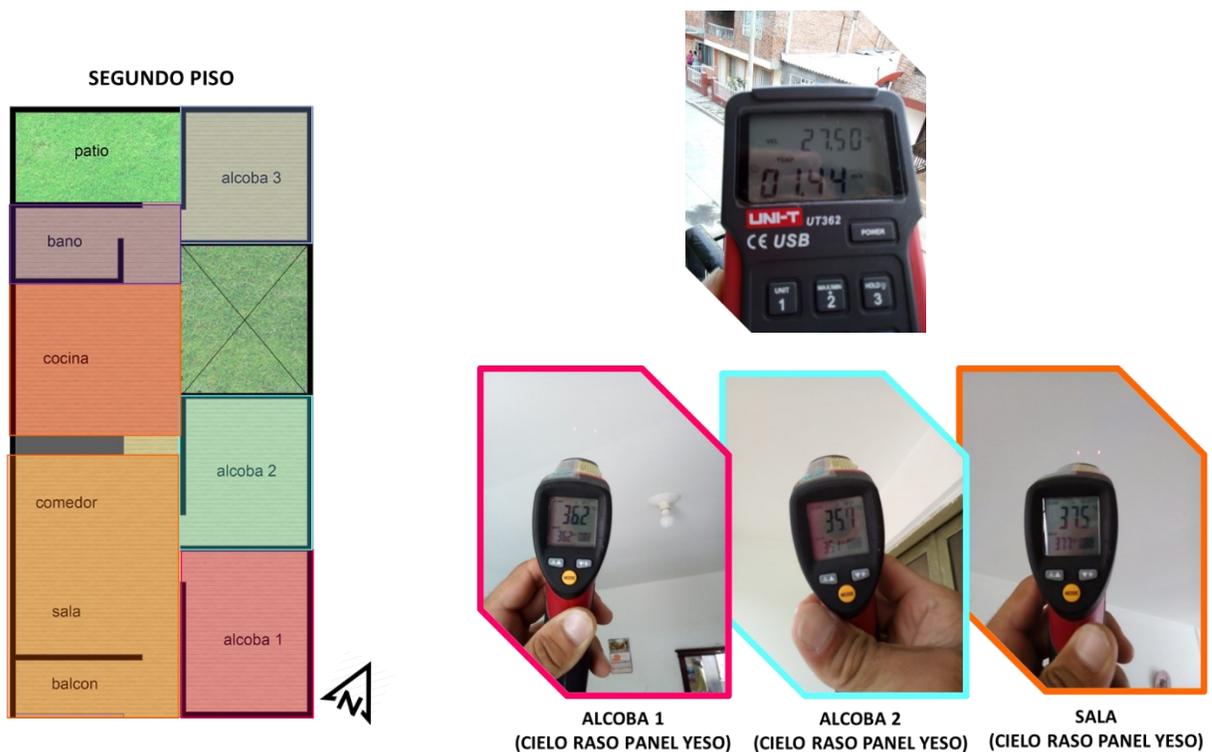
planimetría y fotos Fuente: propia Realizado: abril
